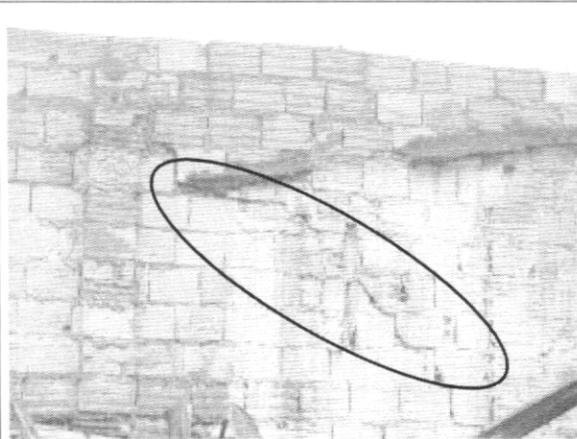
Grieta diagonal, cara interior muro costado oriental
